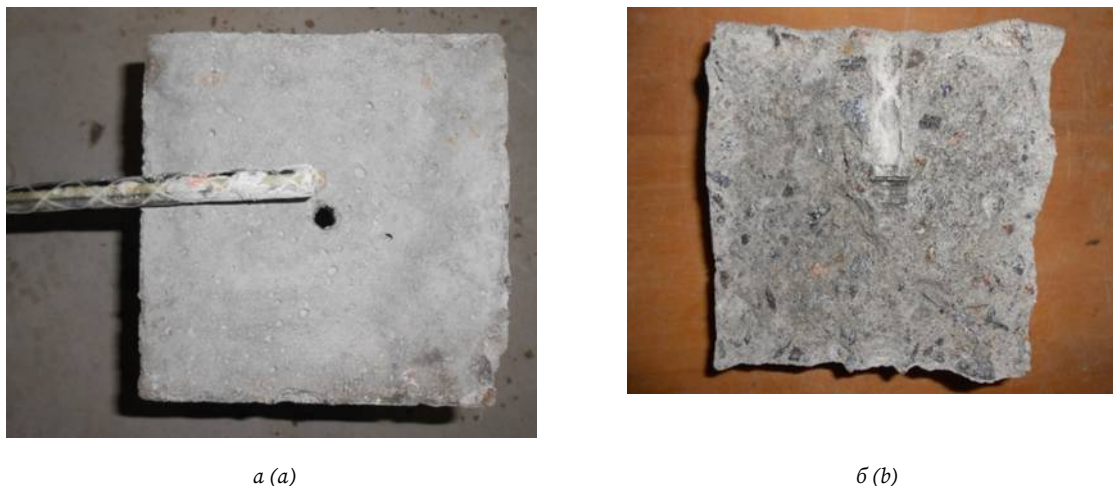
Образец АКП и бетонный куб (а); бетонный куб после испытания (б)
